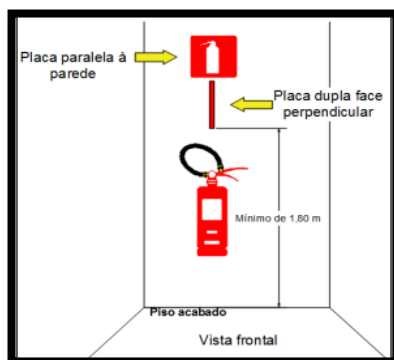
Placa com indicação extintor deve ser colocada a 1,80 do piso do chão.
